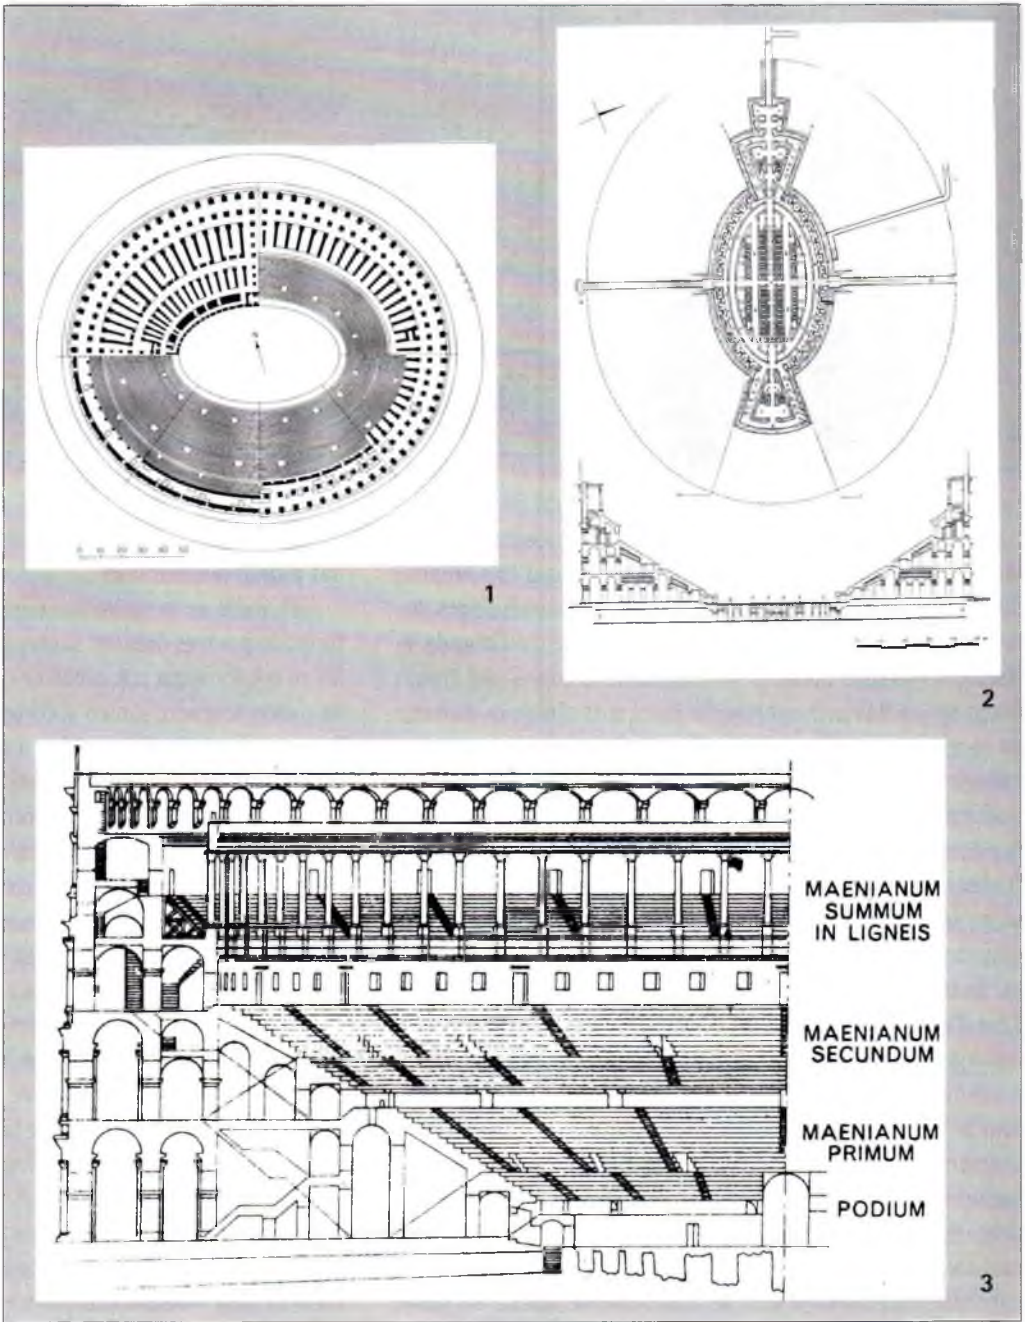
Anfiteatro Flavio. 1: planta. 2: planta de las subestructuras y corte transversal (de J.-C. Golvin). 3: sección de un cuadrante del con indicación de las divisiones de la cávea (de. R. A. Staccioli).
